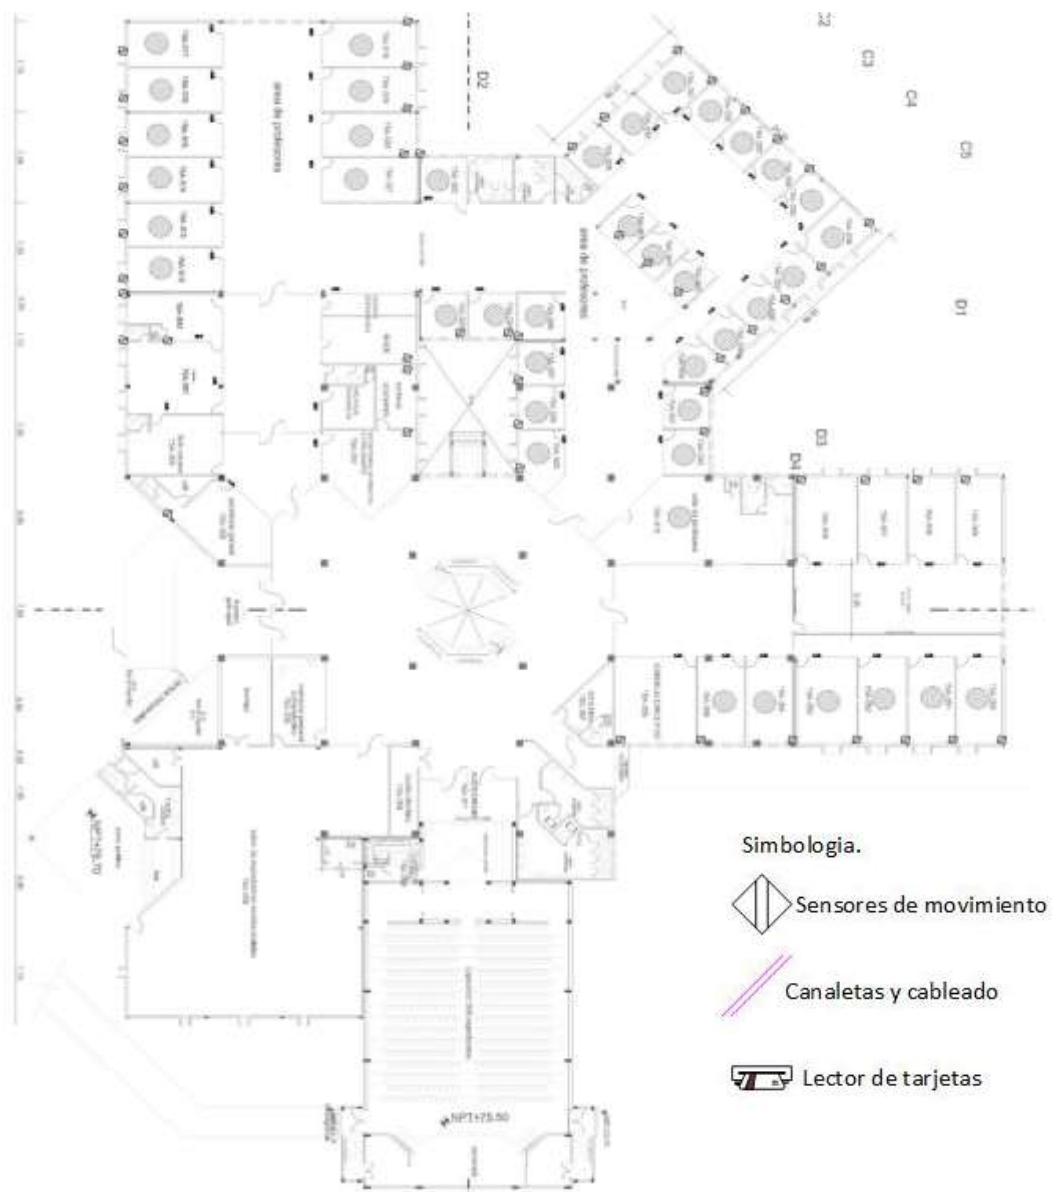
Diseño Estructural del Sistema del Edificio FIEC planta baja
